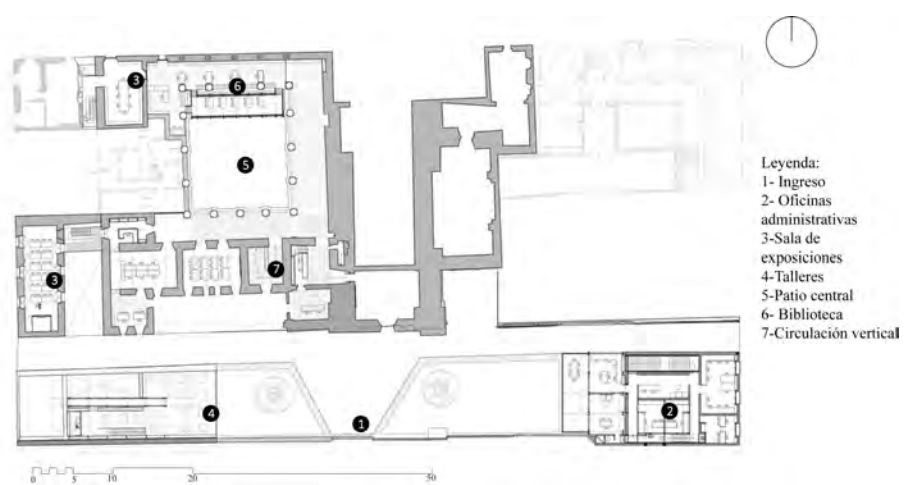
Zonificación de planta baja. Fuente: Nogales (2000). Elaboración: propia.
